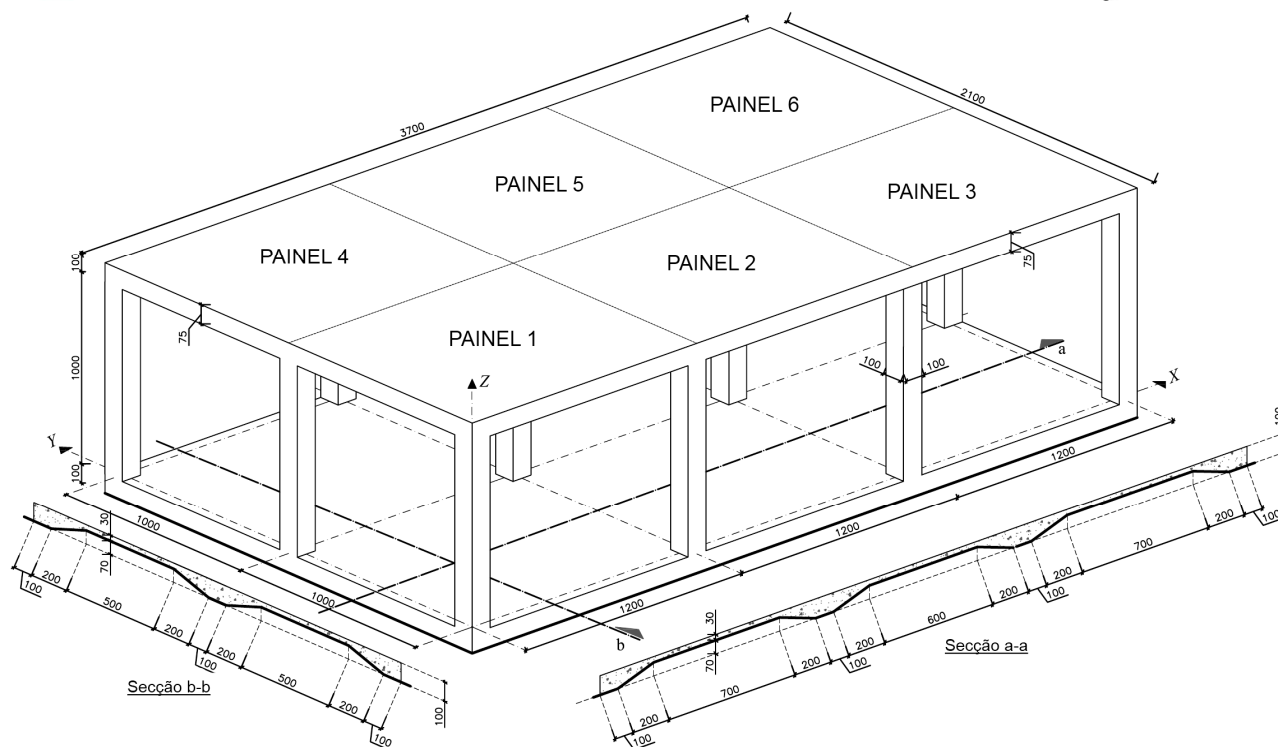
Geometria do protótipo construído em BACRFA (dimensões em mm).
